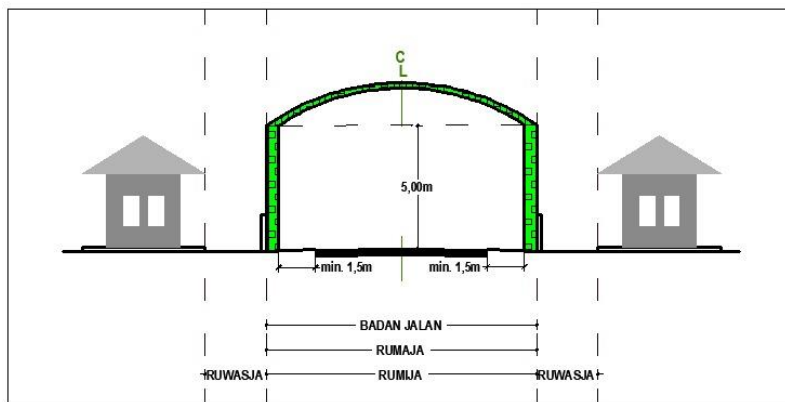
Contoh Penempatan Tugu, Monumen, dan Bangunan Penanda Lainnya di Ruang Milik Jalan Tipe 2
